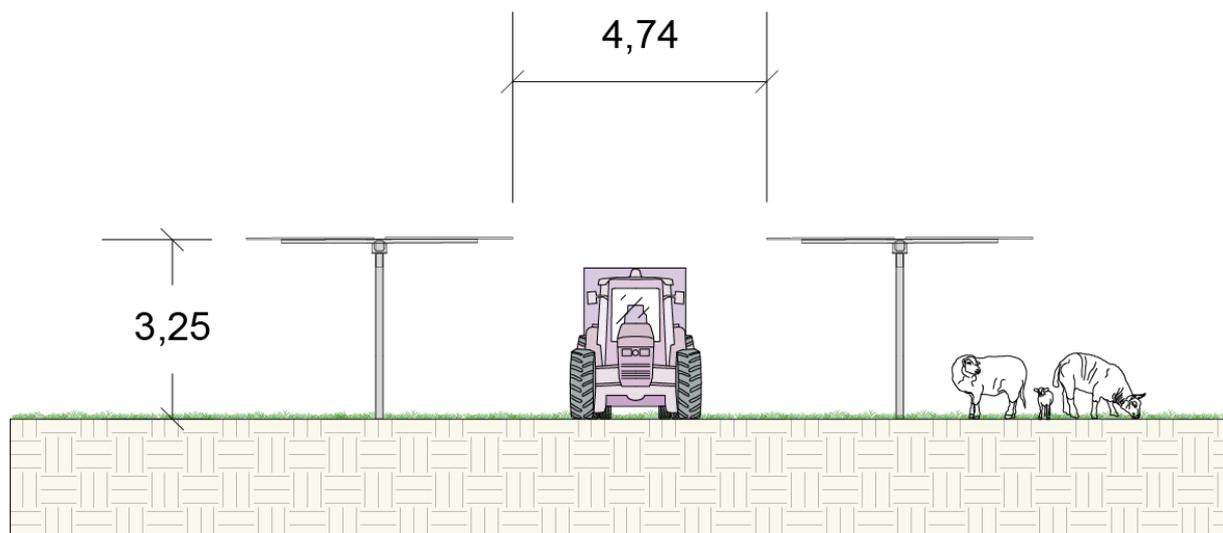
SISTEMA AGRIVOLTAICO ELEVATO, SEZIONE TIPOLOGICA DELL'IMPIANTO
